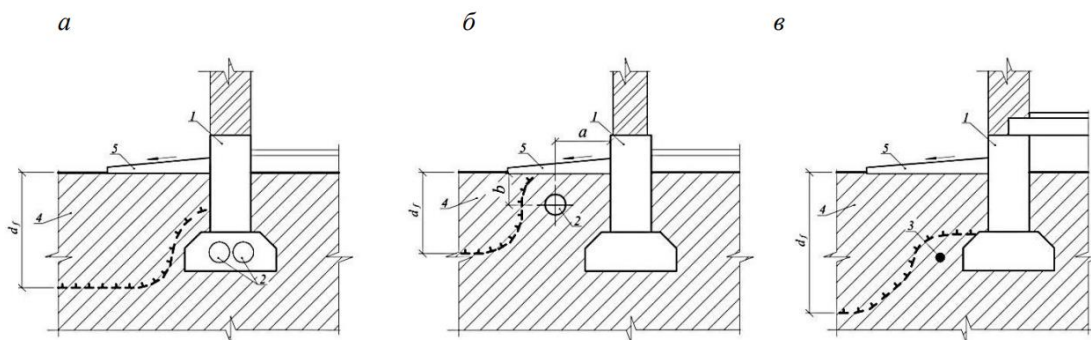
Обогрев грунта: а – прокладка труб отопления в фундаментах; б – прокладка труб отопления возле фундамента; в – прокладка греющего кабеля 1 – фундамент; 2 – трубы отопления; 3 – греющий кабель; 4 – мерзлый грунт; 5 – отмокостка.
